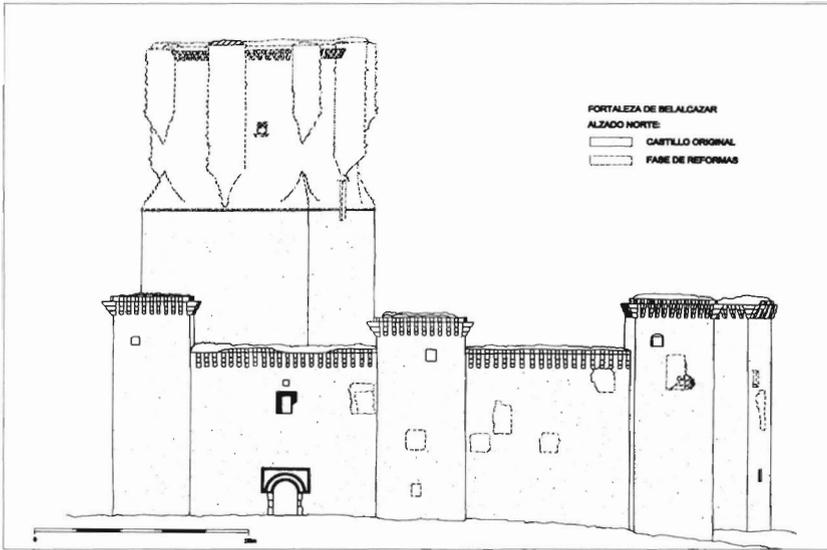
Fortaleza de Belalcázar. Alzado norte.
